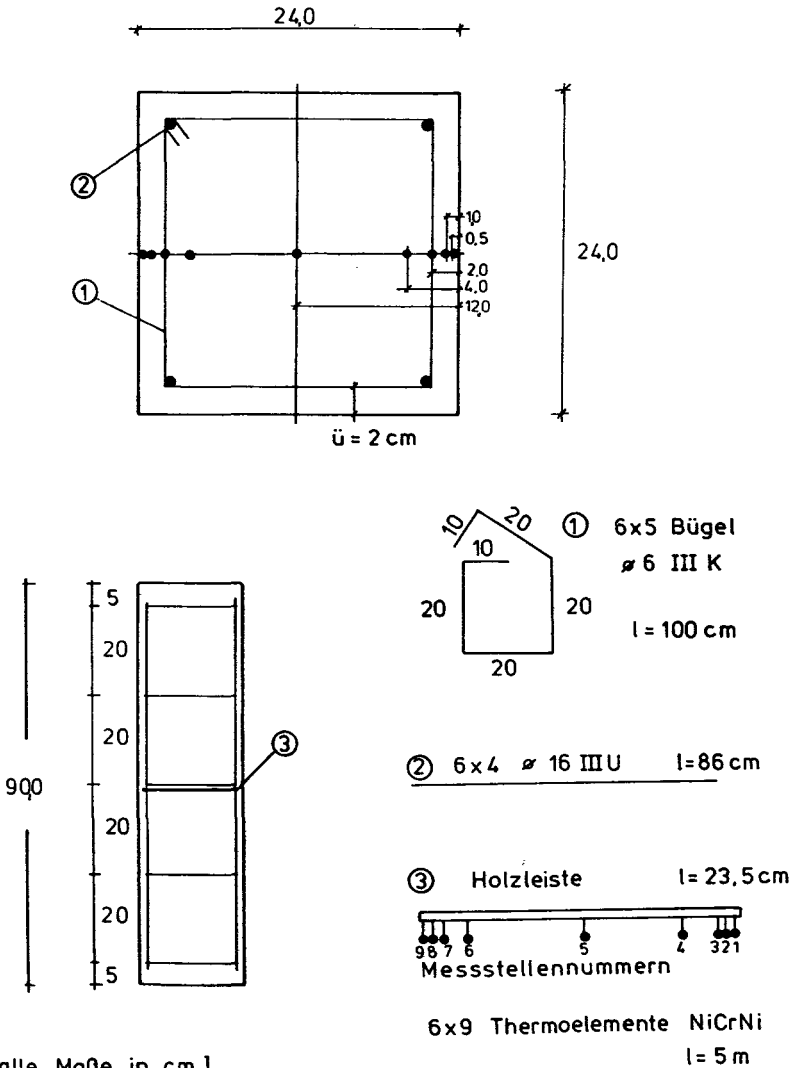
Konstruktionszeichnung des Stahlbeton-Stützenstummels
